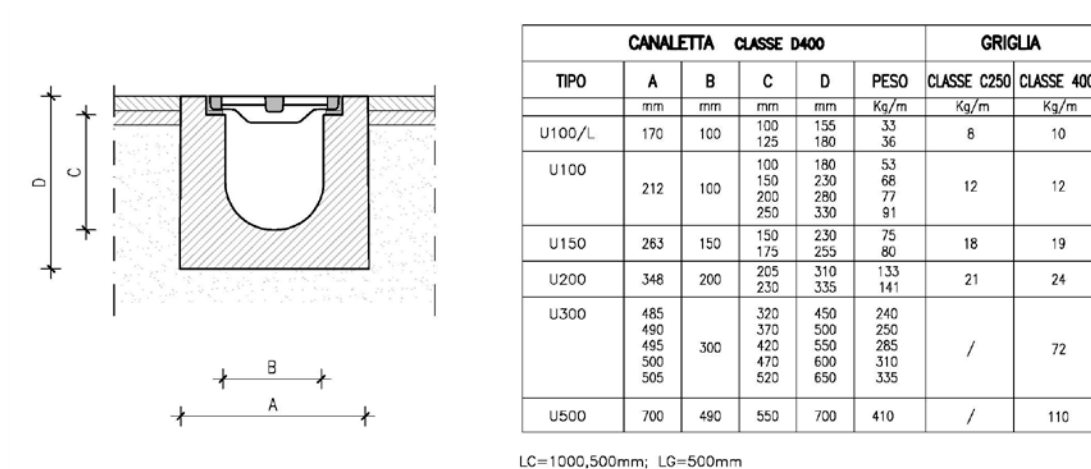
Canalette tipologiche per le rampe del sottopasso stradale
